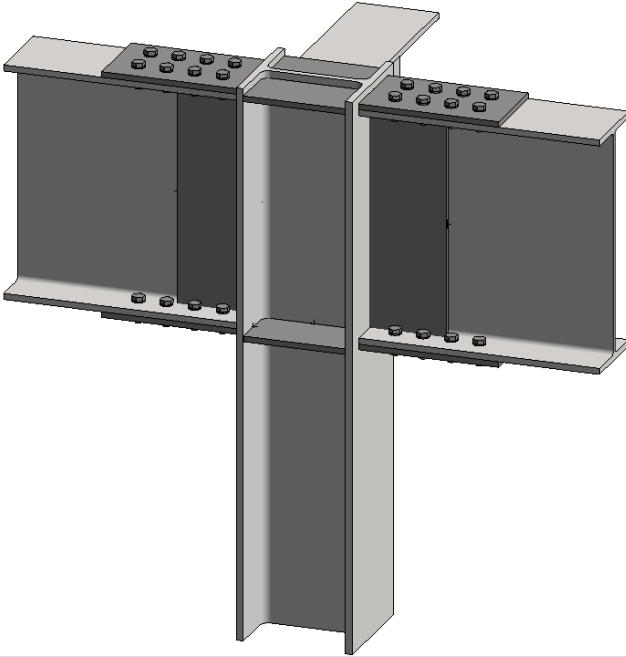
Elaboración propia. Detalle de la conexión BFP en los marcos rígidos de acero en la estructura del edificio.
